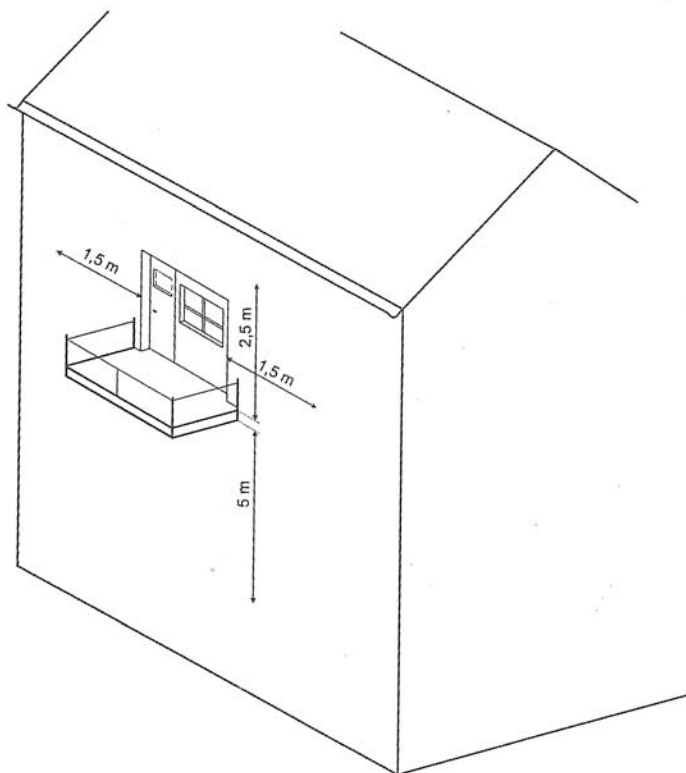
Sortie dans un façade à proximité d'un coin - sans ou verture dans la façade adjacante.
